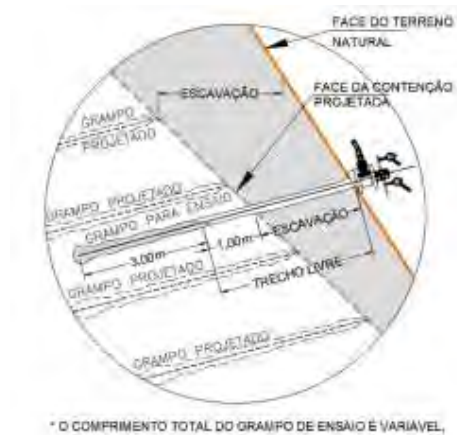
Esquema de implantação do grampo de ensaio.
